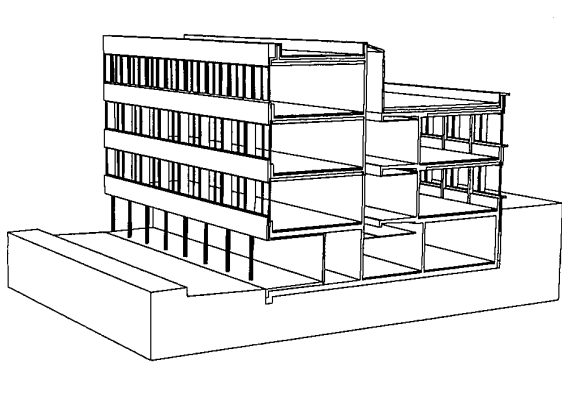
Kantonsschule Kreuzlingen (TG). Wände in Beton, Decken als HBV-Konstruktion. Deckenspannweite 7,4m - Betonkragarm 3,2m. Decke für F60 bemessen
